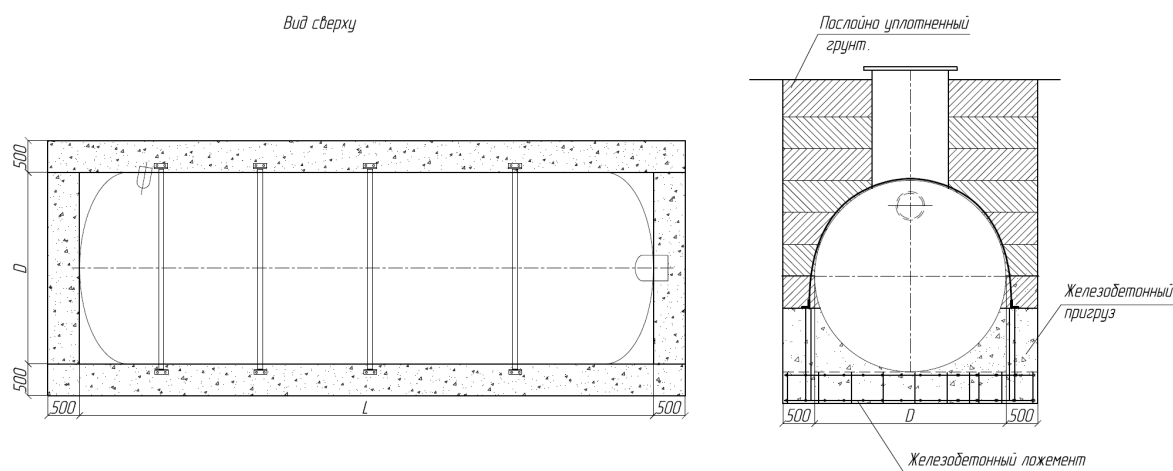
Пример монтажа оборудования при высоком уровне грунтовых вод
